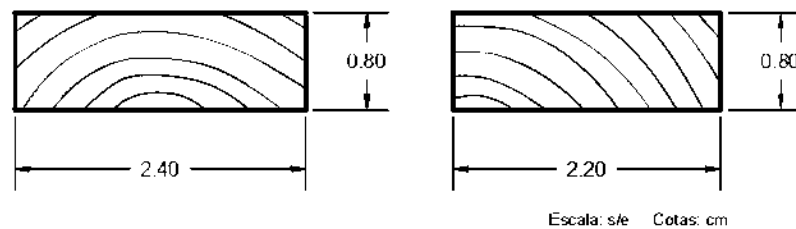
Sección transversal de las láminas para las probetas. Elaboración propia.
